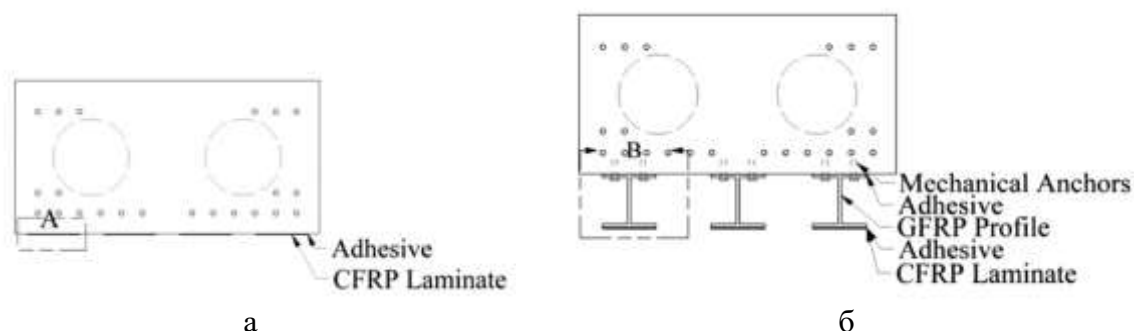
Усиление железобетонной преднапряженной плиты углепластиковыми пластинами: а — по схеме № 1; б — по схеме № 2 (источник [8])
